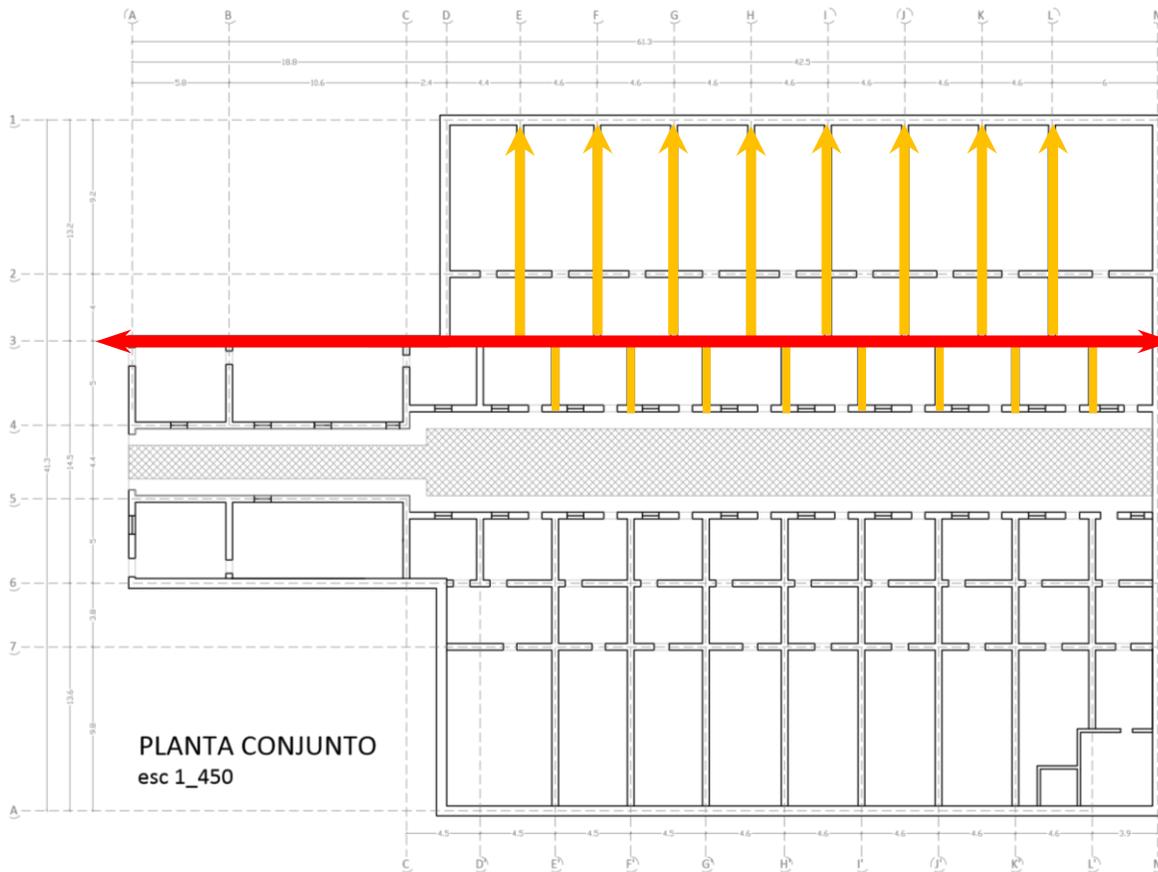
Planta conjunto intervenida, se muestra en rojo el eje 3 y en naranja los ejes verticales.
